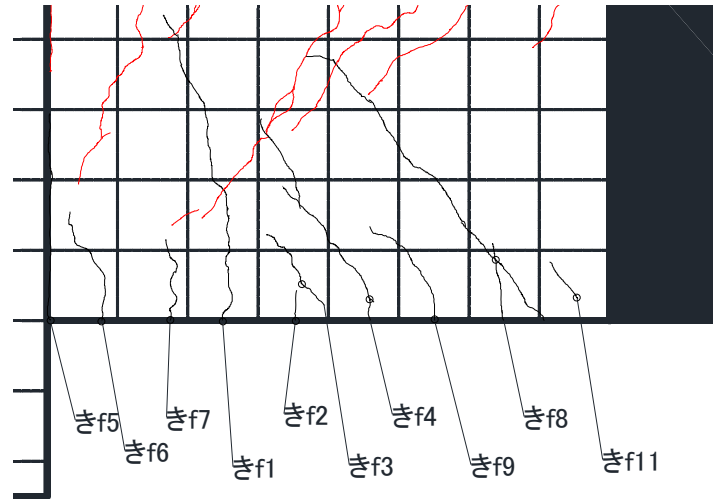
基礎梁ひび割れ幅測定位置 (試験体 DR-4 +7.0 サイクル 観測面)
